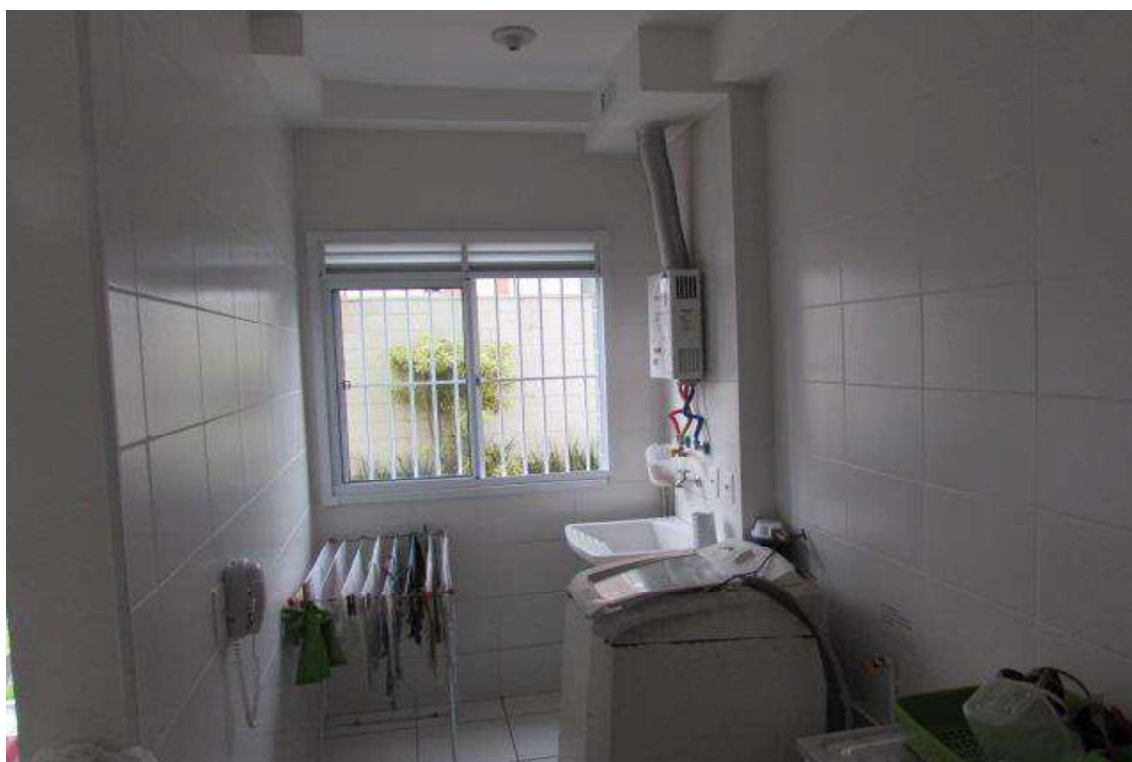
Vista da área de serviço com os mesmos acabamentos construtivos da cozinha.
